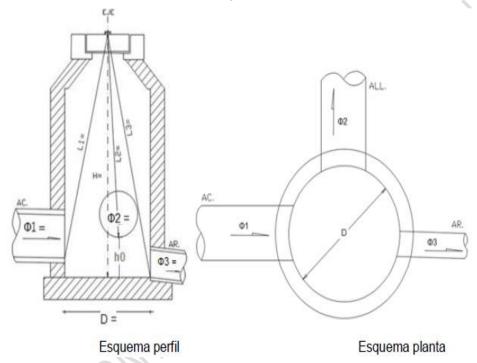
Vista en perfil y planta del aliviadero de orificio.
